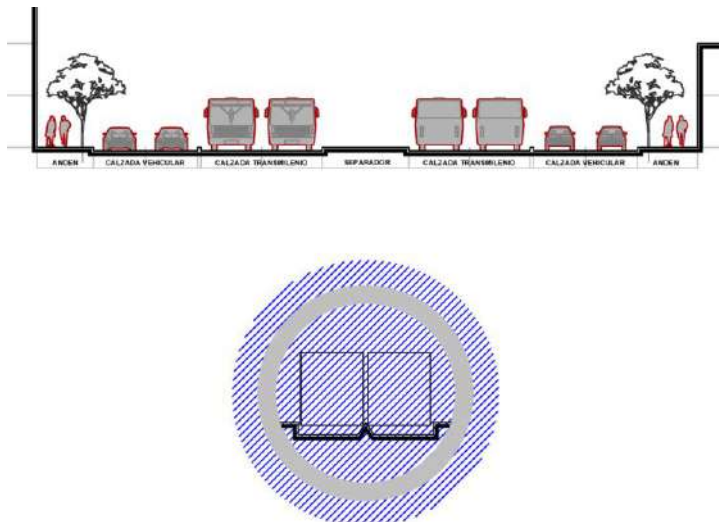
Afectación al tráfico sistema constructivo elevado
